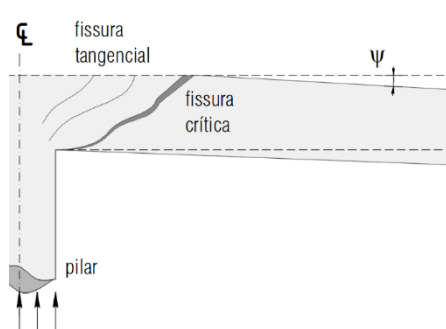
Fissura crítica e rotação da laje
